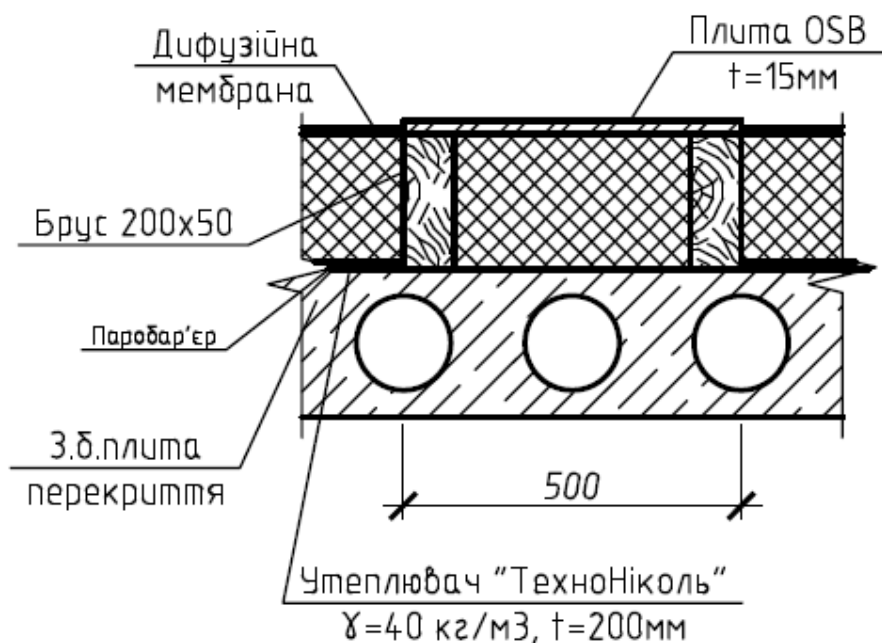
Прийнята конструкція утеплення перекриття.
